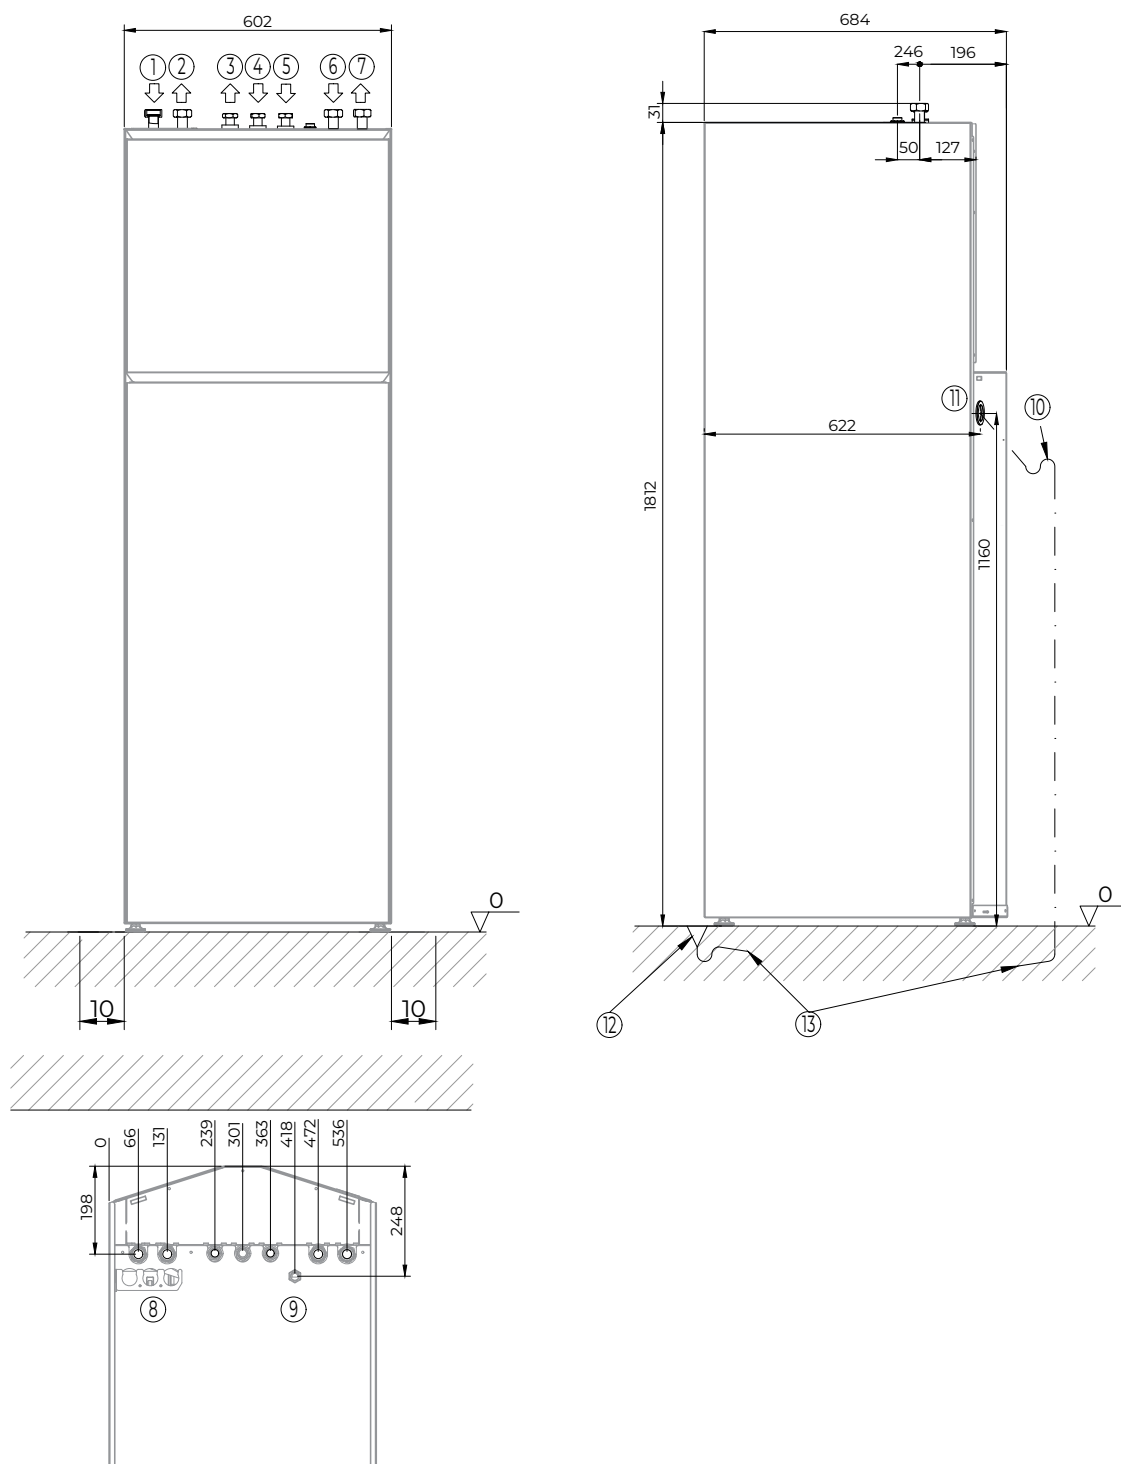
Bijlage 5 - Plan voor de installatie van de HYDRO S2 + HYDRO P2 + HYDRO A2
